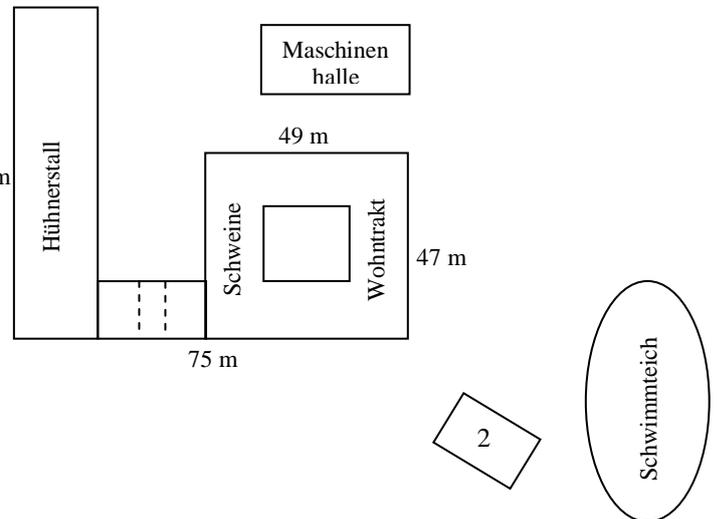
aktueller Grundriss des Vierkanthofes mit Anbau, Schmitt'n bzw. Badehaus und Schwimmteich
